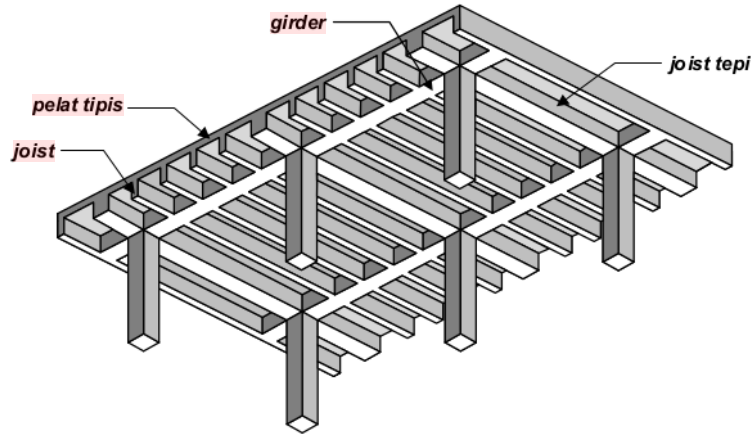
Penggunaan balok antara dua arah pada sistem lantai slab di atas girder.
